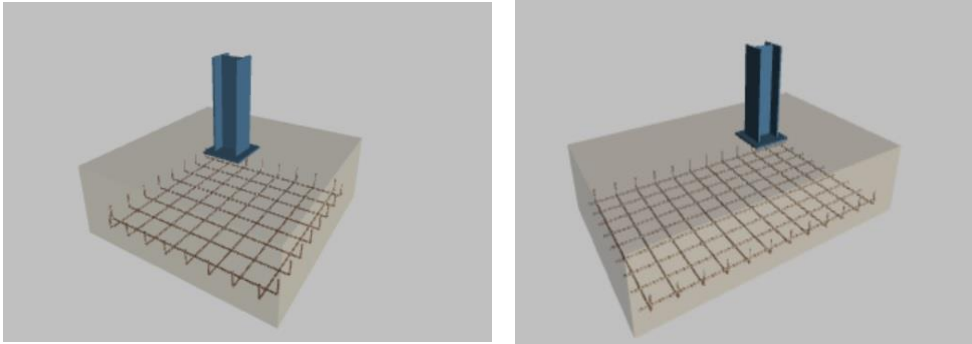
Zapata centrada cuadrada. Fuente: CYPE 3D. Figura 15: Zapata rectangular excéntrica. Fuente: CYPE 3D
